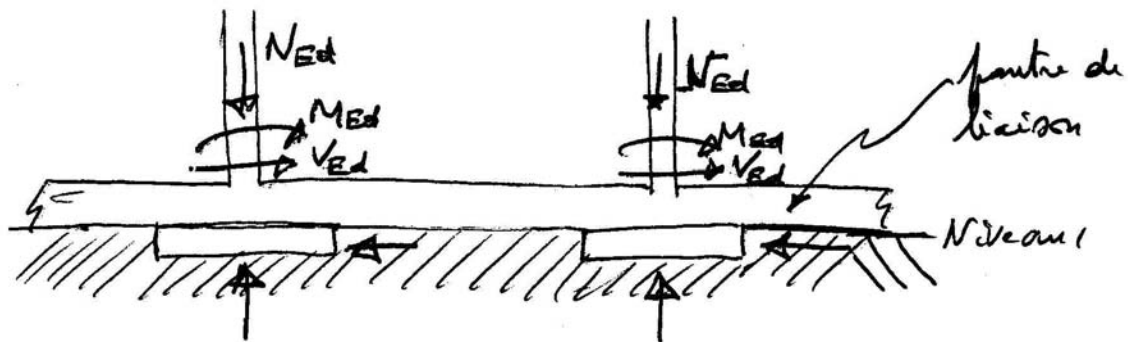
Une forte poutre de liaison entre pieds de portique évite la transmission au sous sol des moments en pied de chaque poteau.
